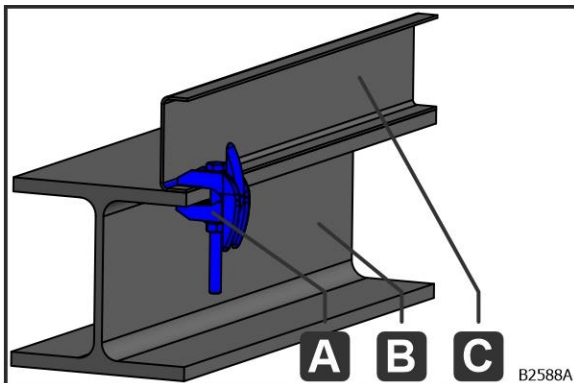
Befestigung mit Trägerklemme F9 (A)
